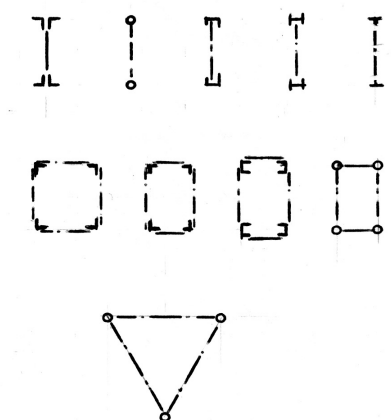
Поперечні перерізи ферм: плоскі, коробчасті, трикутні
